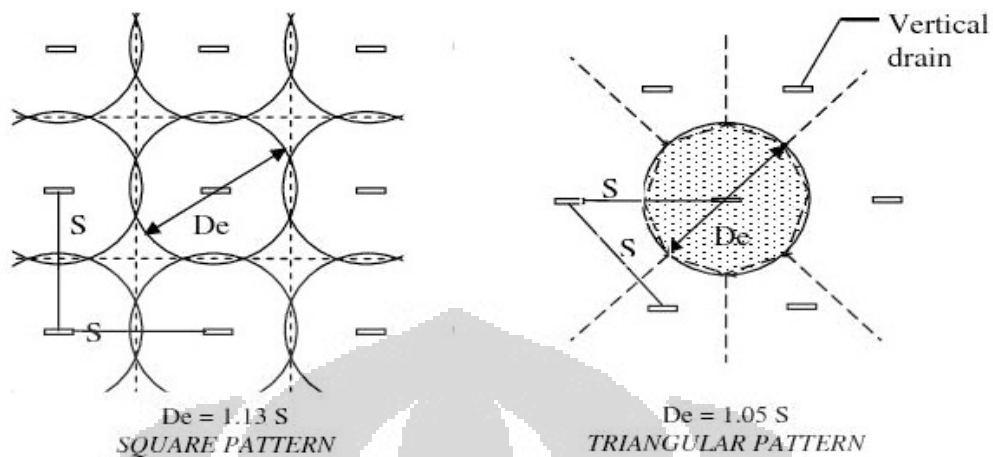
Aliran air tanah dengan bantuan vertikal drain
